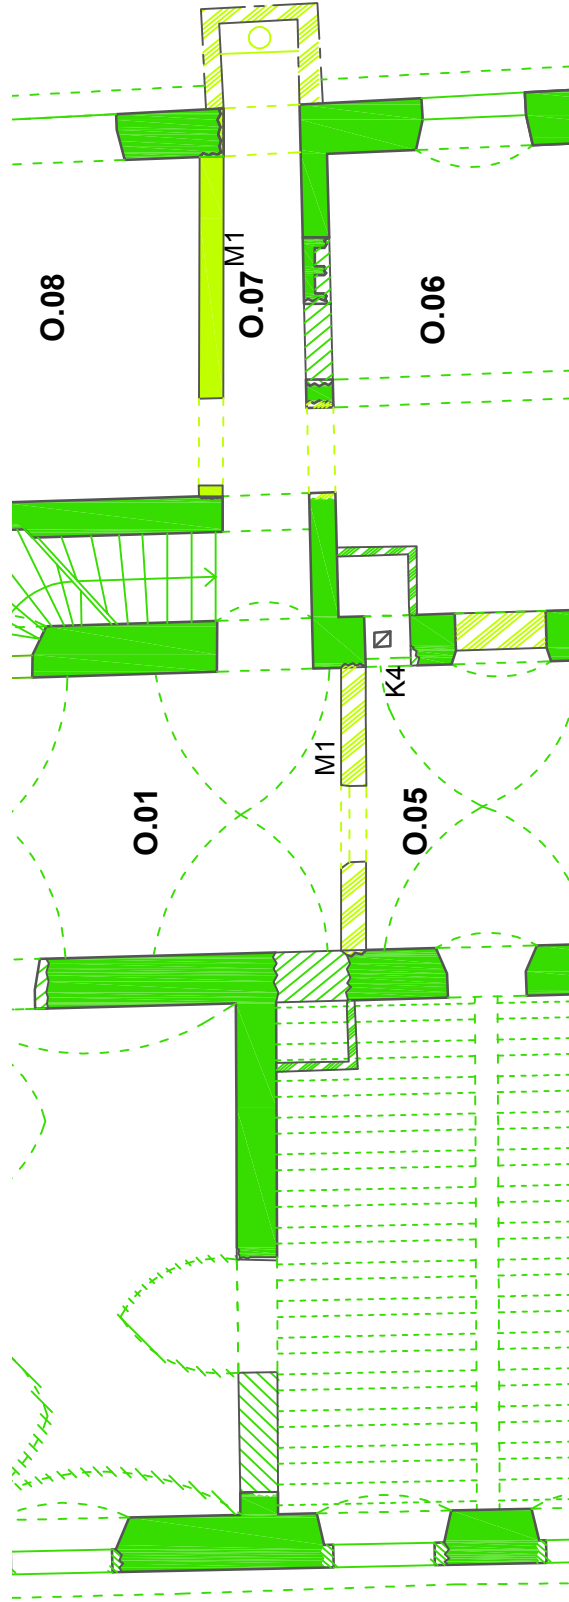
TEILGRUNDRISS OBERGESCHOß BPh III
